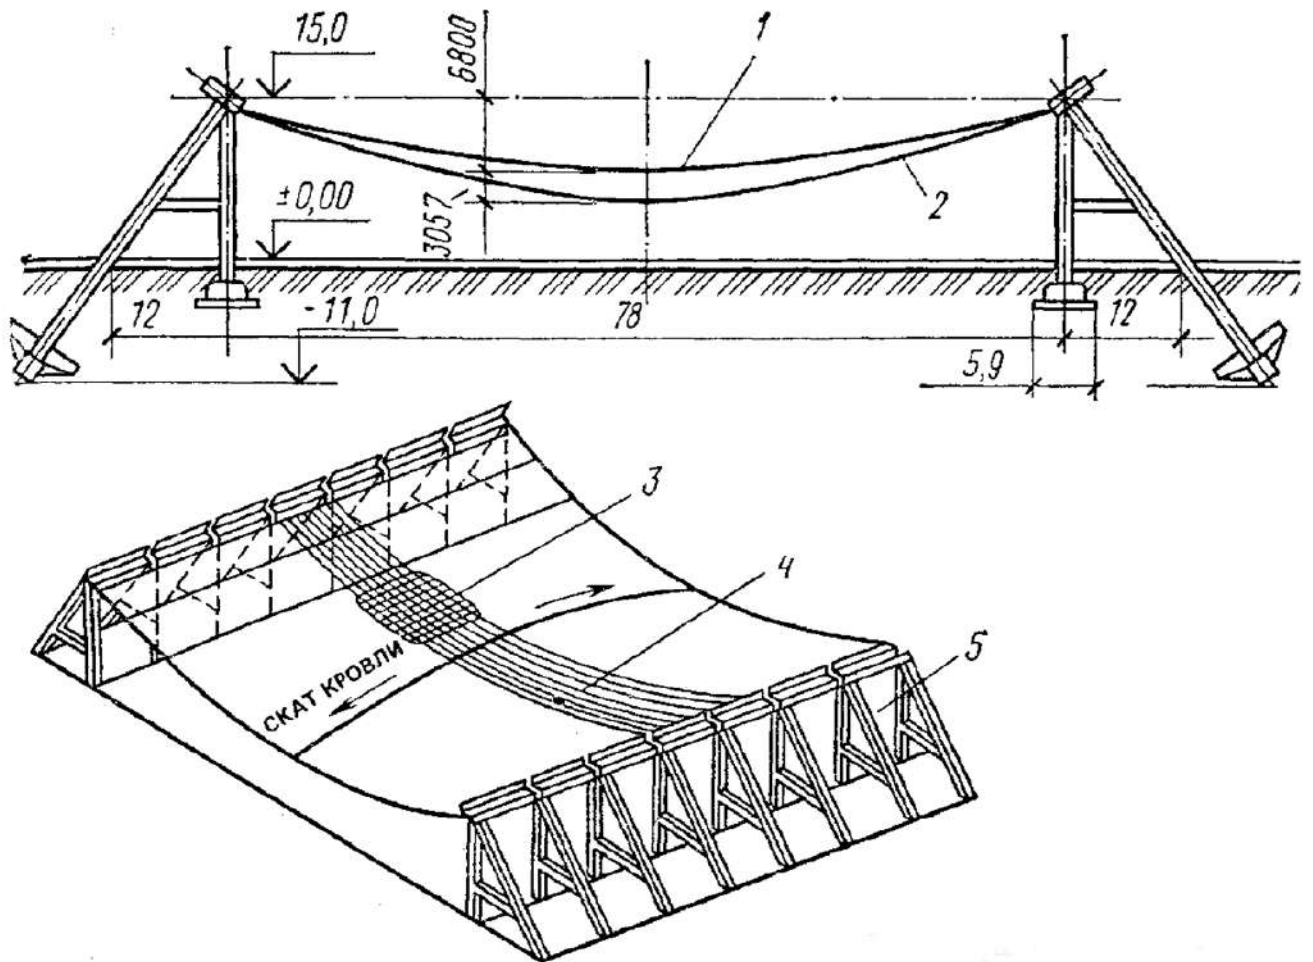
Покрытие гаража в Красноярске: 1, 2, 4 – несущие стержни > 40 мм через 1,5 м; 3- железобетонные плиты; 5 – опорная конструкция
